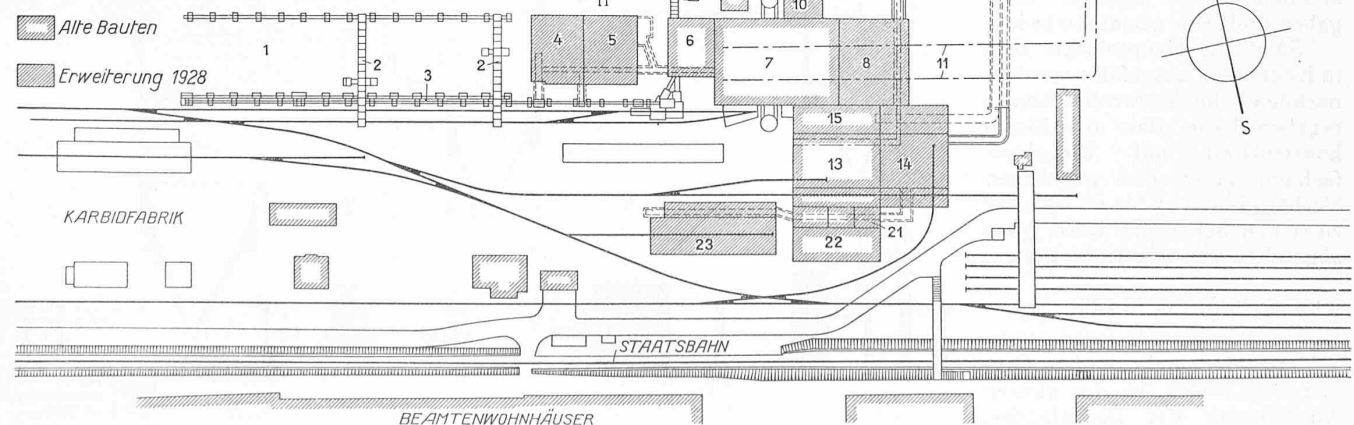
Lageplan des Dampfkraftwerkes Laziska-Górne nach seiner Erweiterung im Jahre 1928. — Masstab 1 : 3000.
